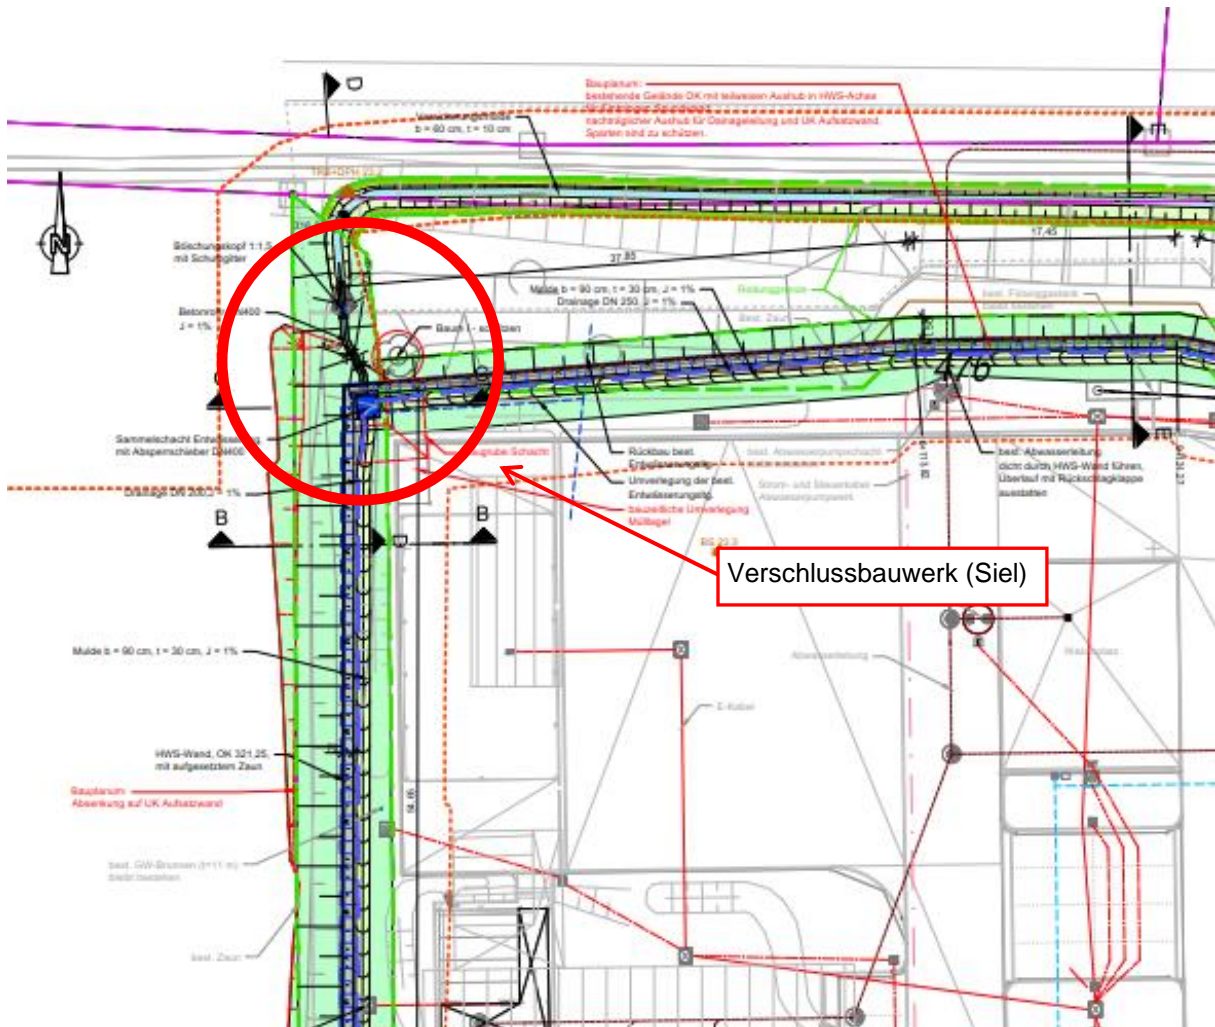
Verschlussbauwerk (Siel) DN 600 in der HWS-Wand am OS WSV, Lageplan (aus Plan 04-07-01)
